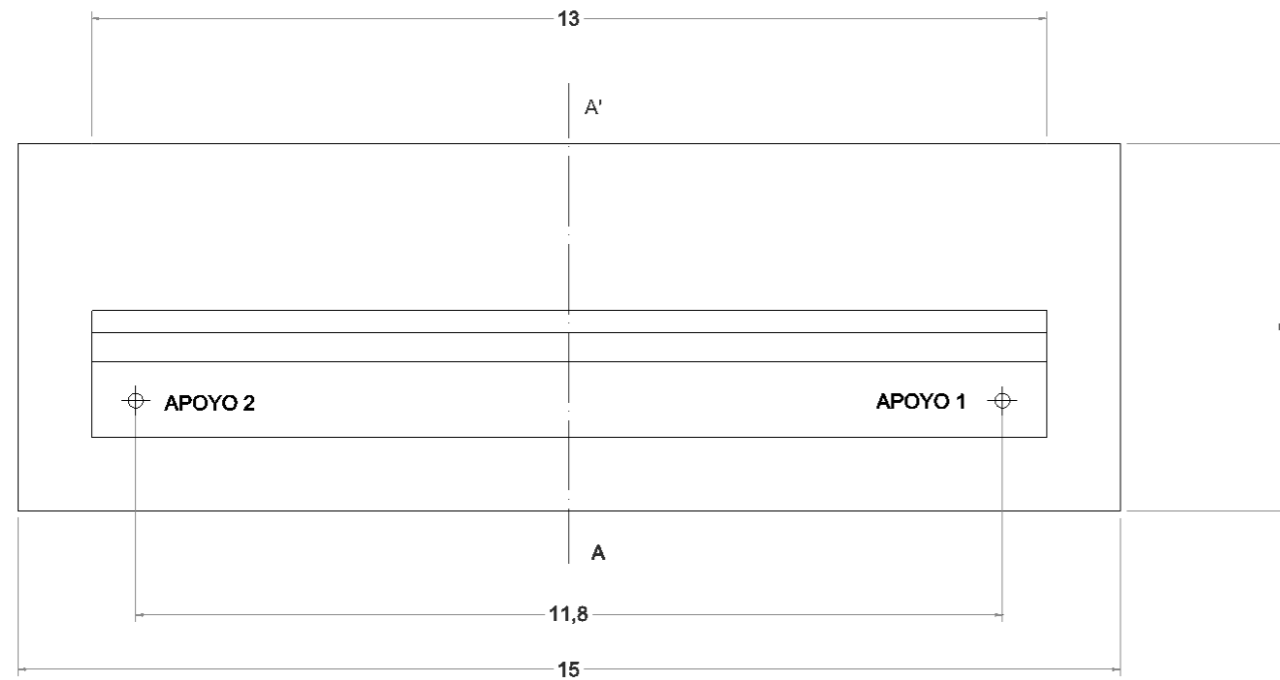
Planta estribo, unidades en m (Fuente: Elaboración propia)
